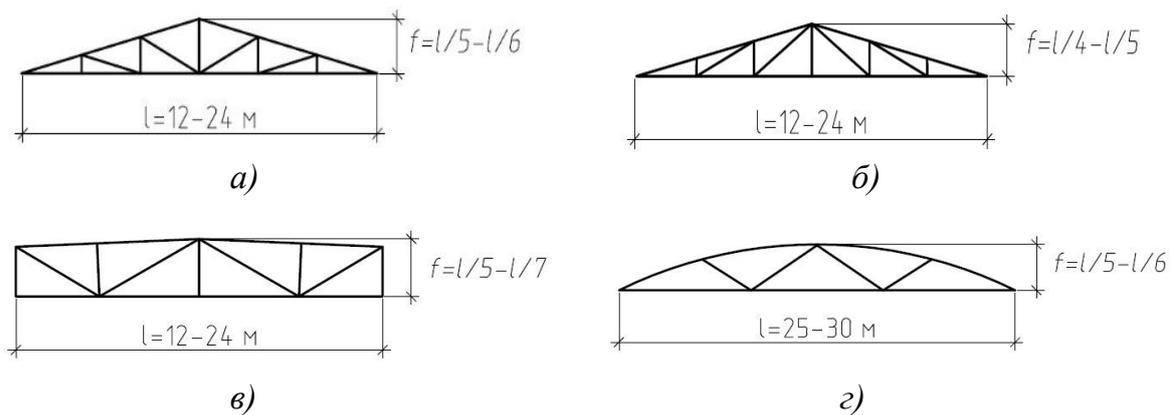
Кледеревянные фермы: а – треугольная с нисходящими раскосами; б – то же с восходящими раскосами; в – сегментная; г – пятиугольная
